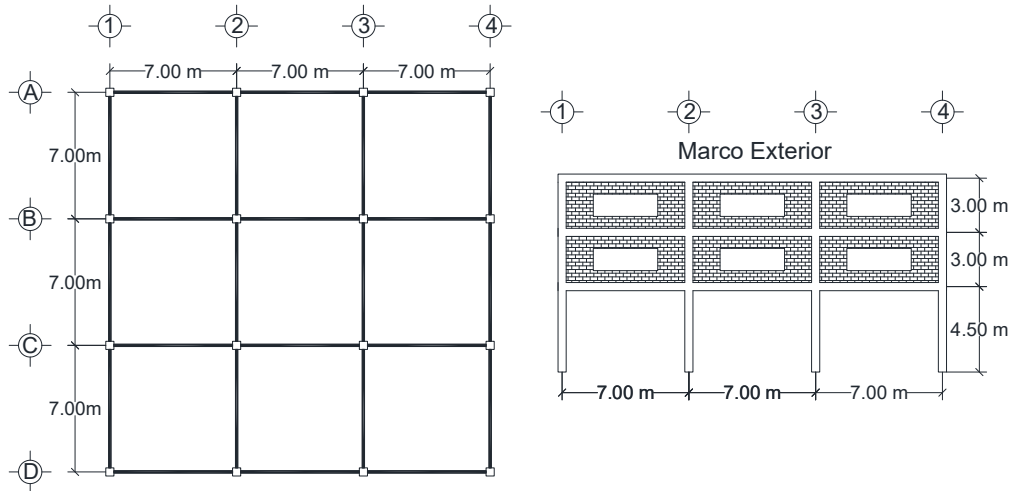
Distribución en planta y elevación del edificio de 3 niveles considerado en este estudio.
